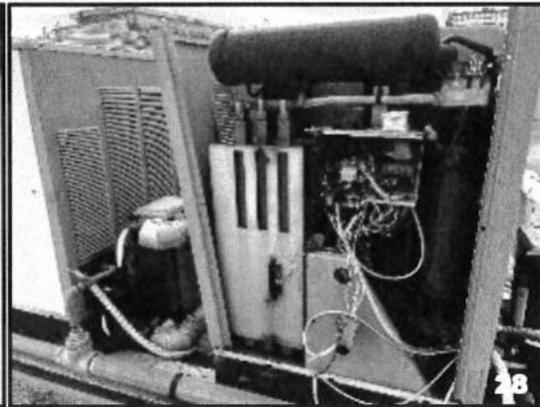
e 28 - Terrazza: macchine condizionamento climatico e dettaglio stato manutentivo di una
